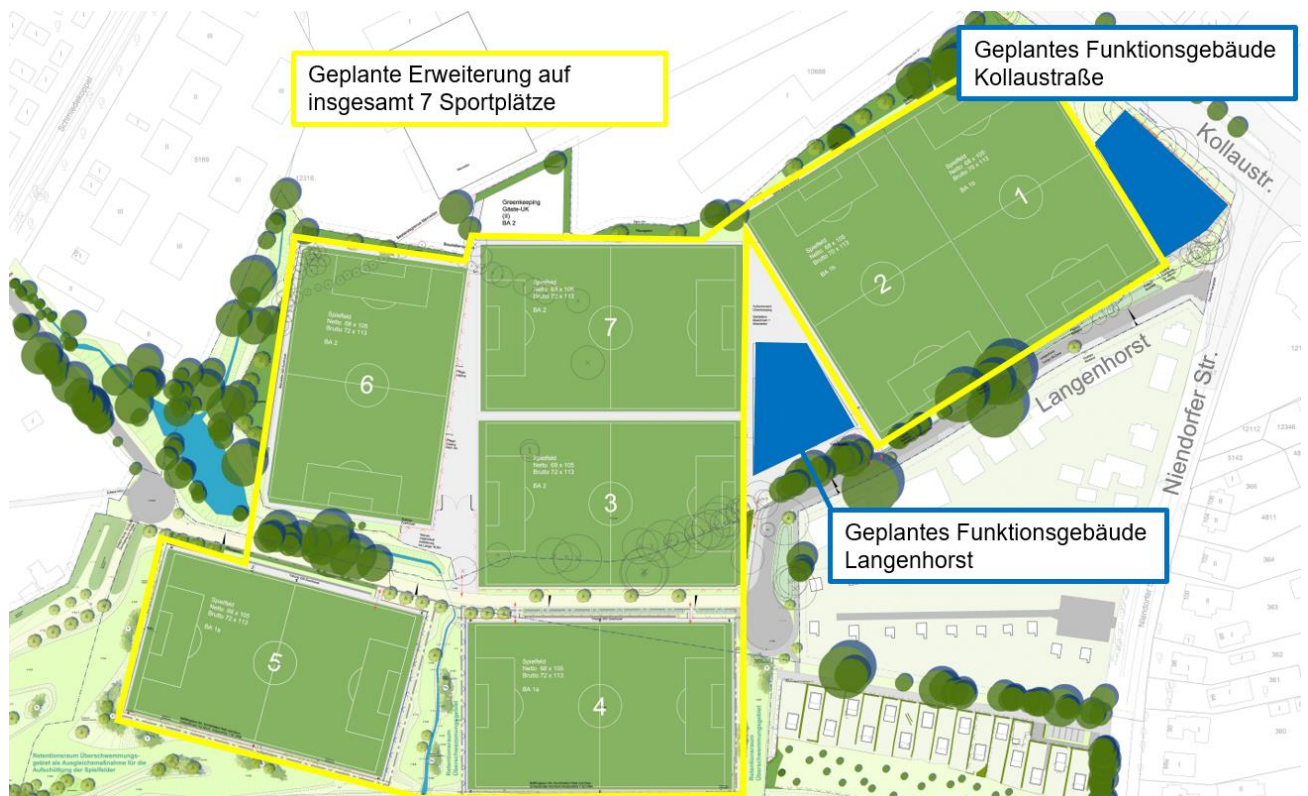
Übersichtslageplan Bauvorhaben (Plangrundlage: Munder und Erzepky Landschaftsarchitekten bdlA, Norden oben)
